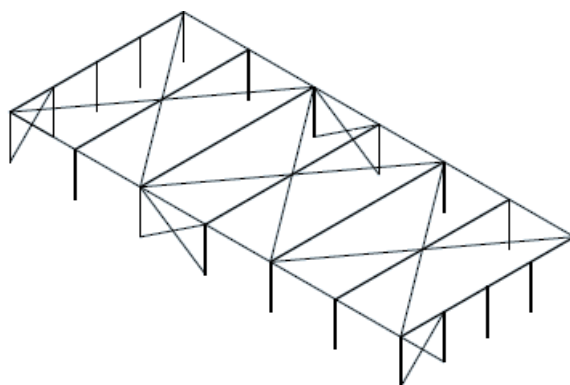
Esquema estrutural de um edifício com pórticos de vigas simplesmente apoiadas (adaptado do relatório do projeto SECHALO, 2012)
